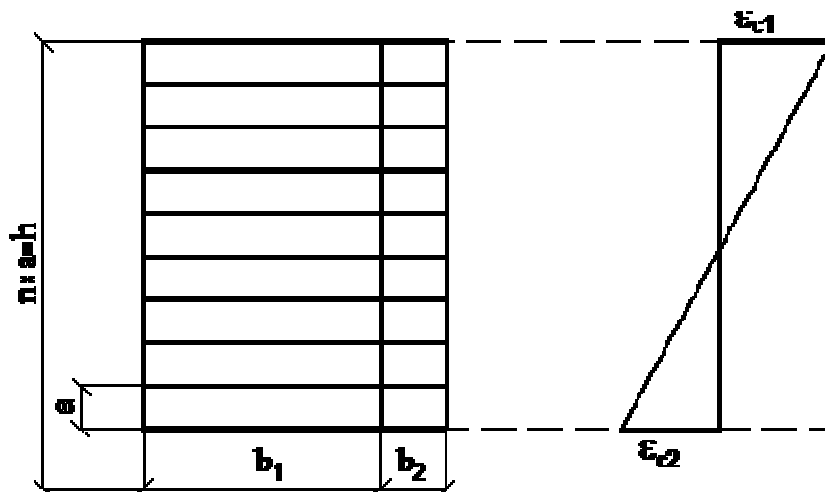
Схема до розрахунку поперечного перерізу двошарового елемента
